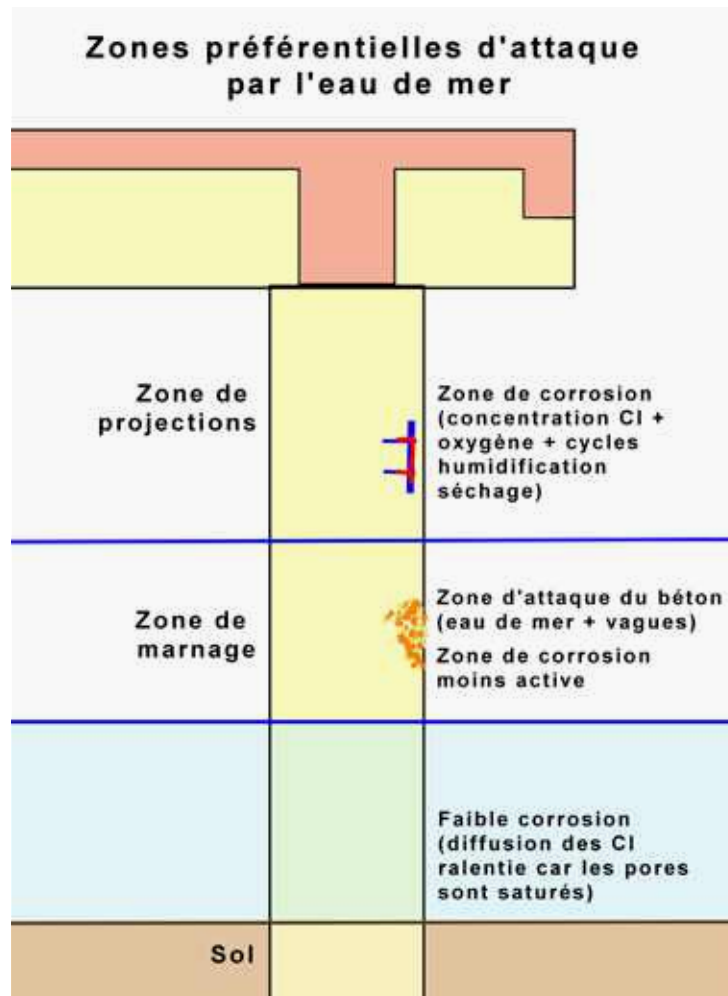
zones préférentielles d'attaque par l'eau de mer d'une structure
